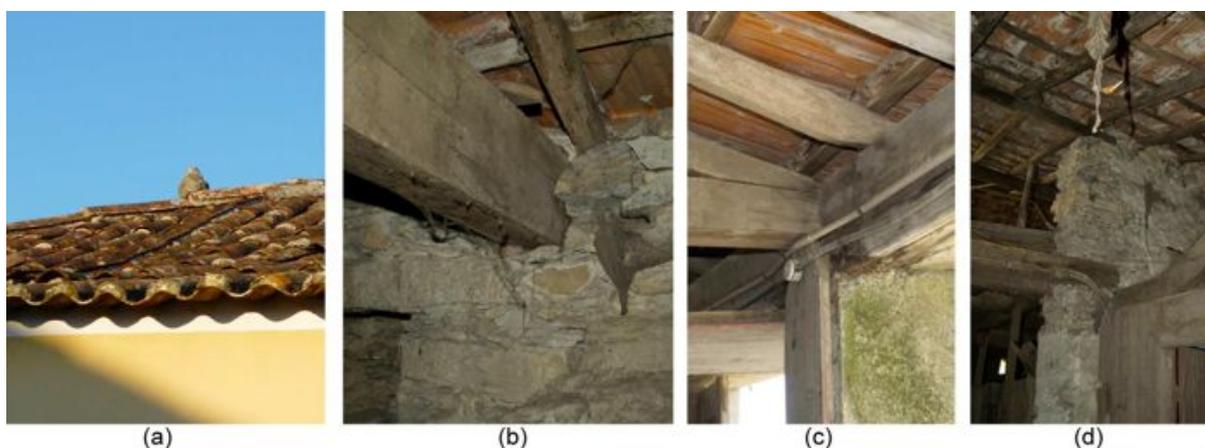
a) Cobertura tradicional revestida a telha caleira artesanal (CR5); (b) Viga de cobertura encastrada (CR4); (c) Vigas apoiadas sobre frechal (CR4); (d) Linha de cobertura apoiado em parede divisória estrutural (CR4)
